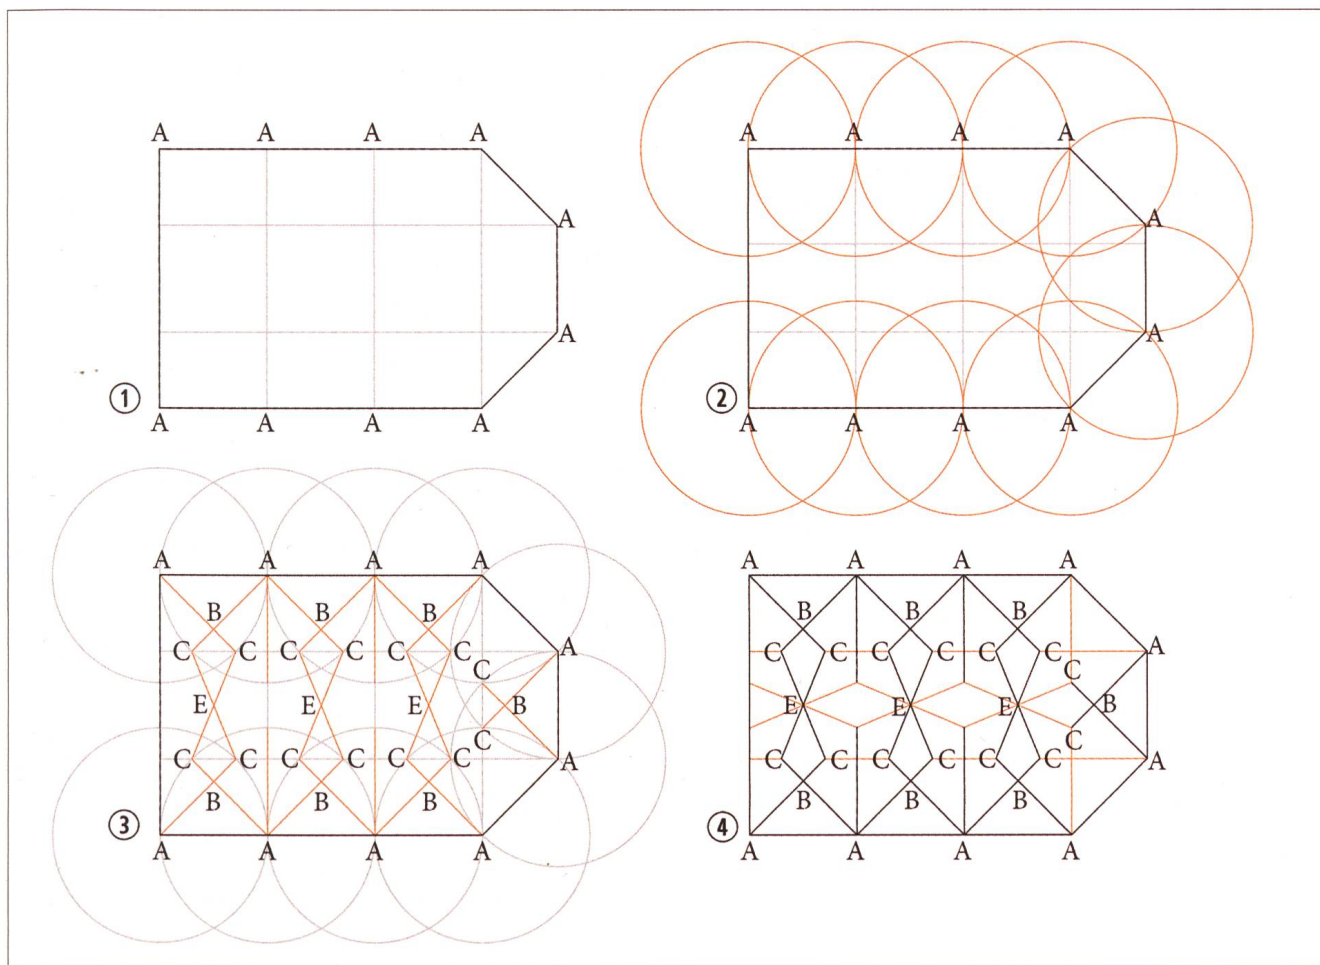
Mögliche Rekonstruktion der Planung eines Haspelsterngewölbes im Grundriss.
